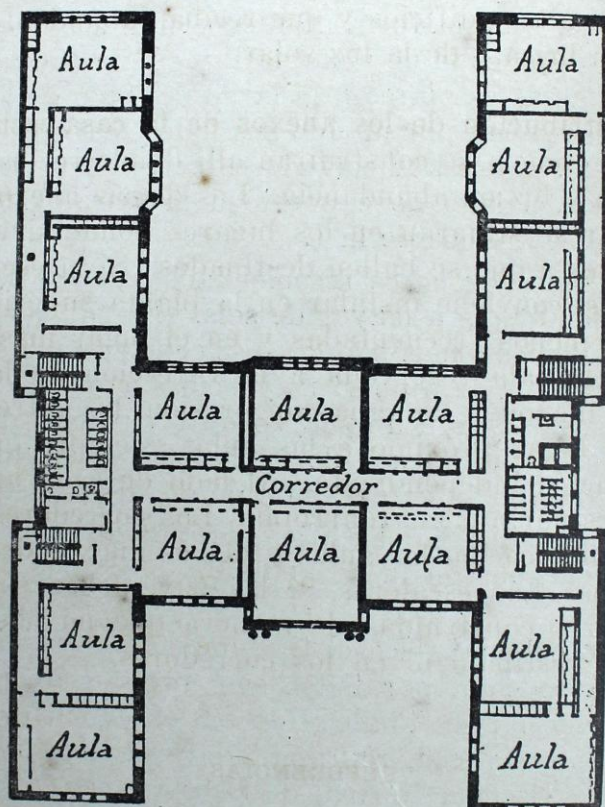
Plano de una escuela de forma de H. Planta baja.
